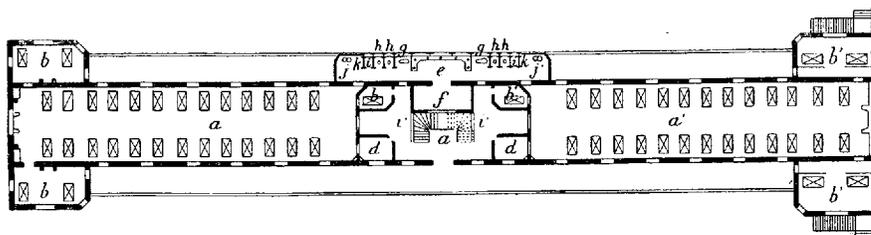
Plan du pavillon de l'hôpital de Montpellier (1<sup>er</sup> étage).
